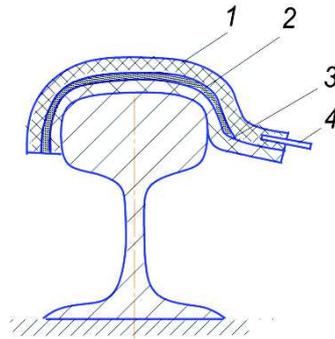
Принципиальная схема упрочнения сварного шва рельсового стыка:
